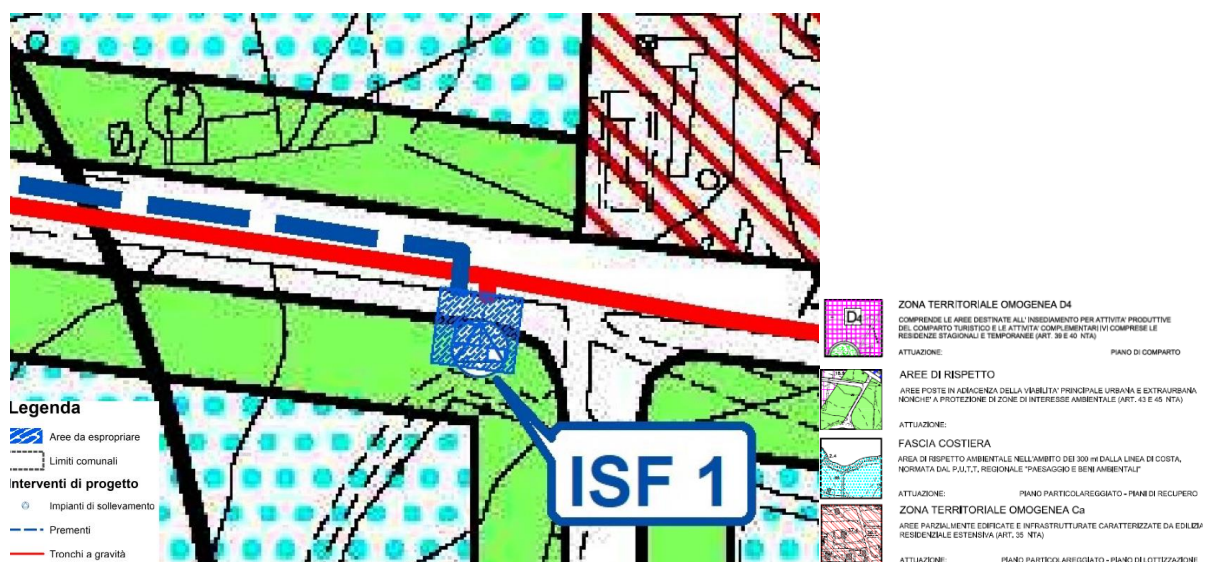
Sovrapposizione impianto di sollevamento compatto ISF1 con strumento urbanistico vigente
